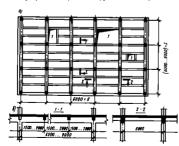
, Моналитное ребристое железобетонное перекрытие:
